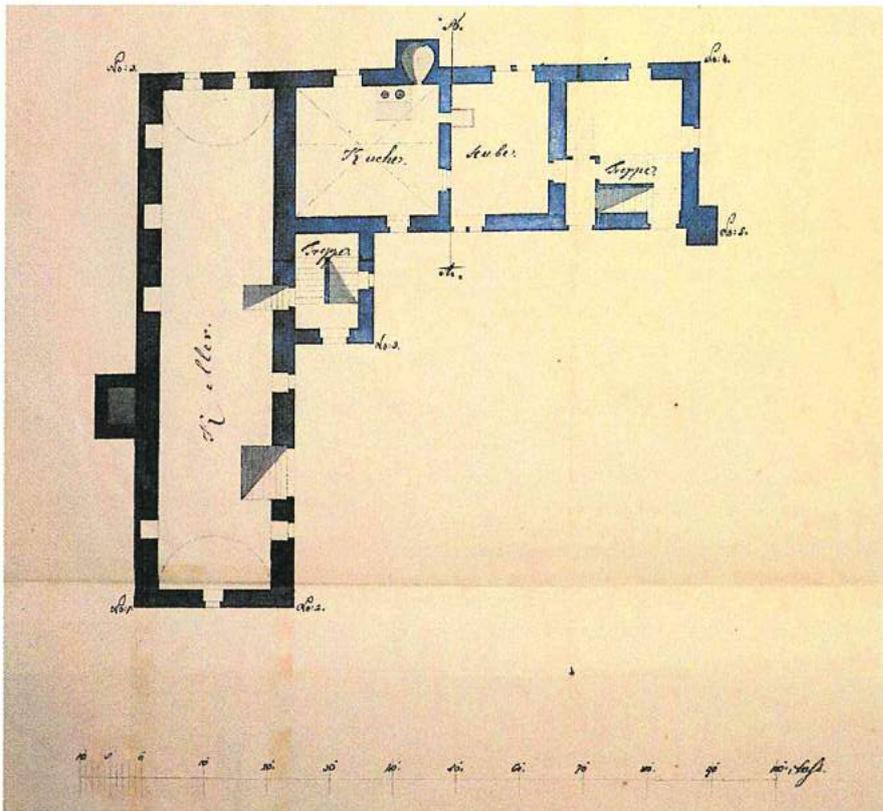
Grundriss des Iten Stockes über Das Schloss in Kirchhofen, Quelle: GLAK G Kirchhofen 3.
